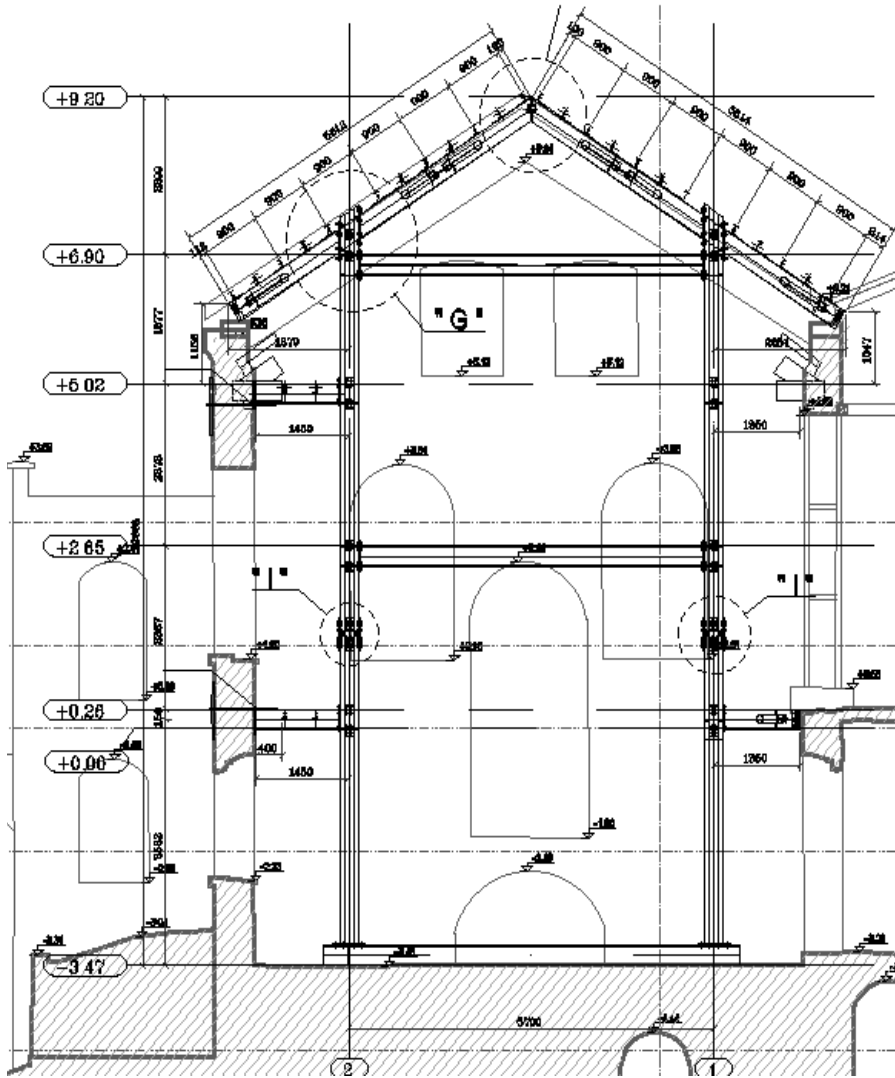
Transmasyon ve Sikkehâne mahalleri arasında görülen muhdes açıklık ve çelik profiller
